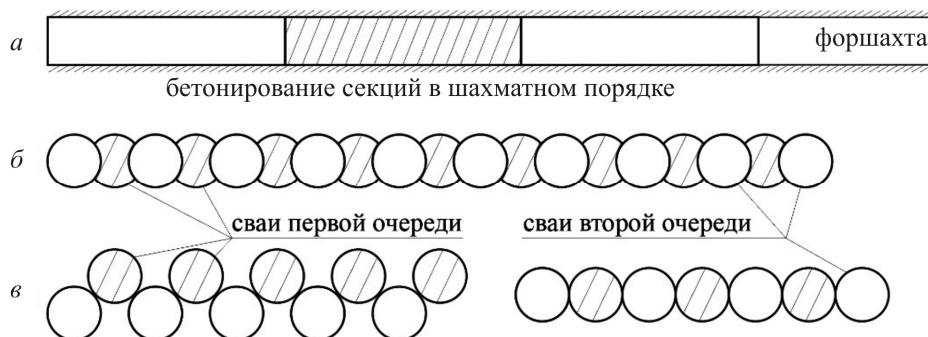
Схема конструкций, устраиваемых способом «стена в грунте»: а – монолитная траншейная «стена в грунте»; б – свайная «стена в грунте» из буросекущихся свай; в – свайная «стена в грунте» из бурокасательных свай
